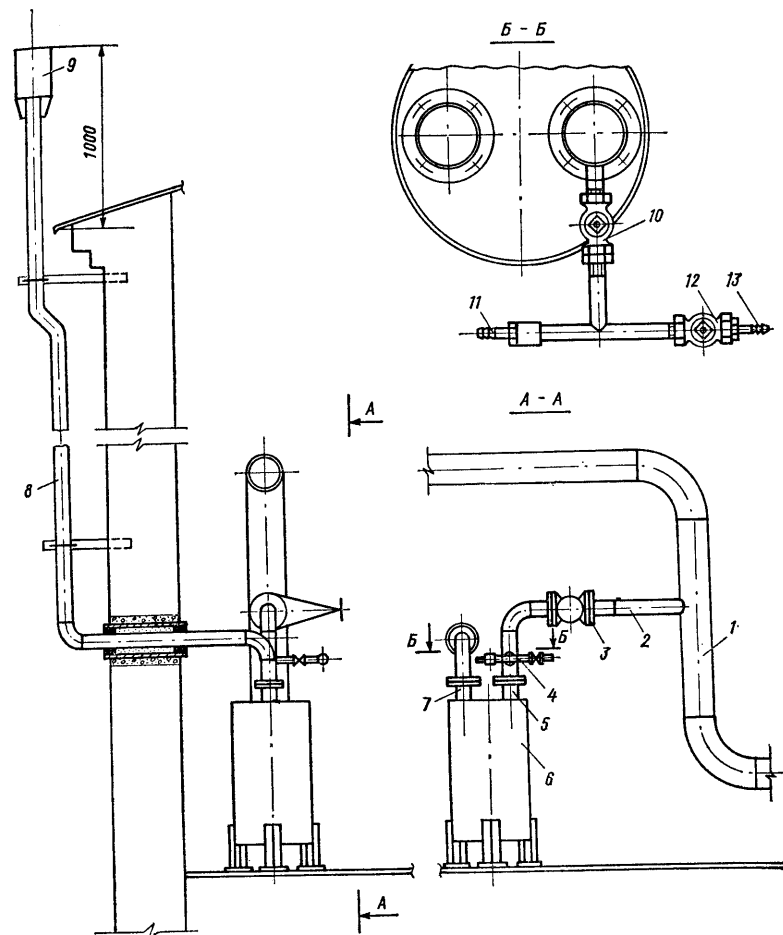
Установка ГП с приспособлением для его настройки.
